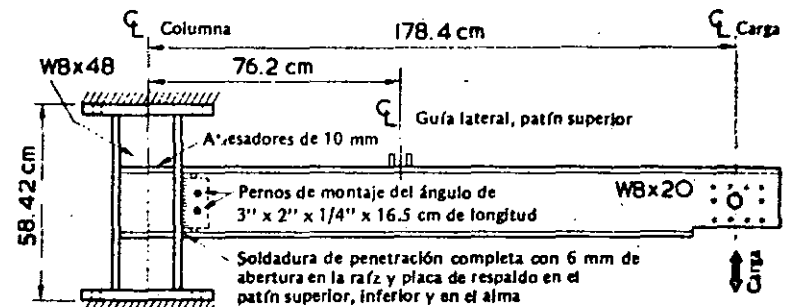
Especimen de una conexión soldada viga-columna (según Popov y Pinkney^{4,9}).
